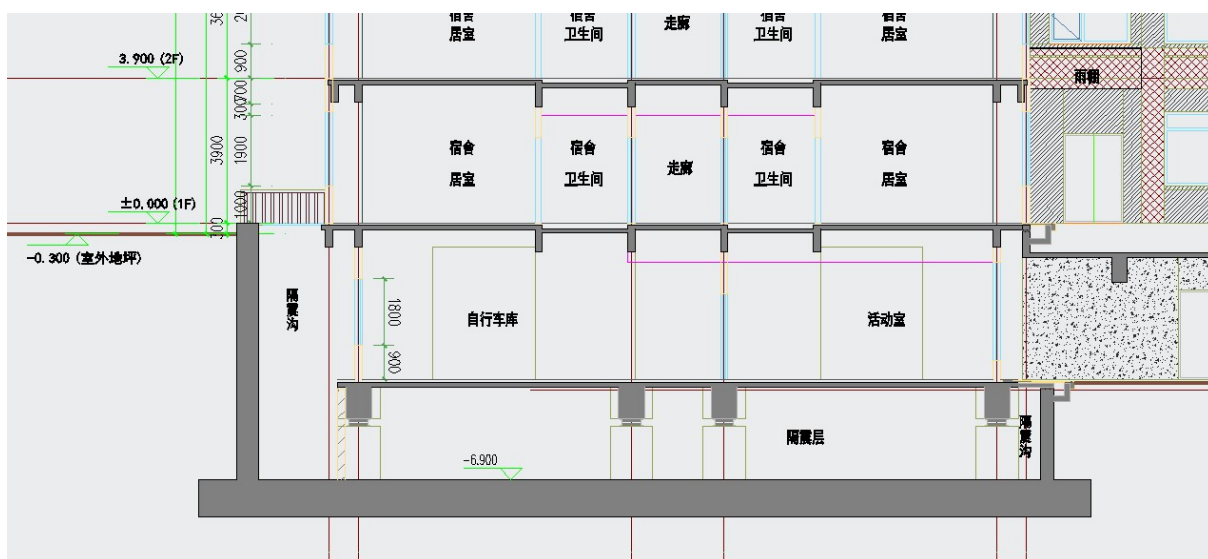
E04-06-07 地块学生宿舍地下室剖面图
